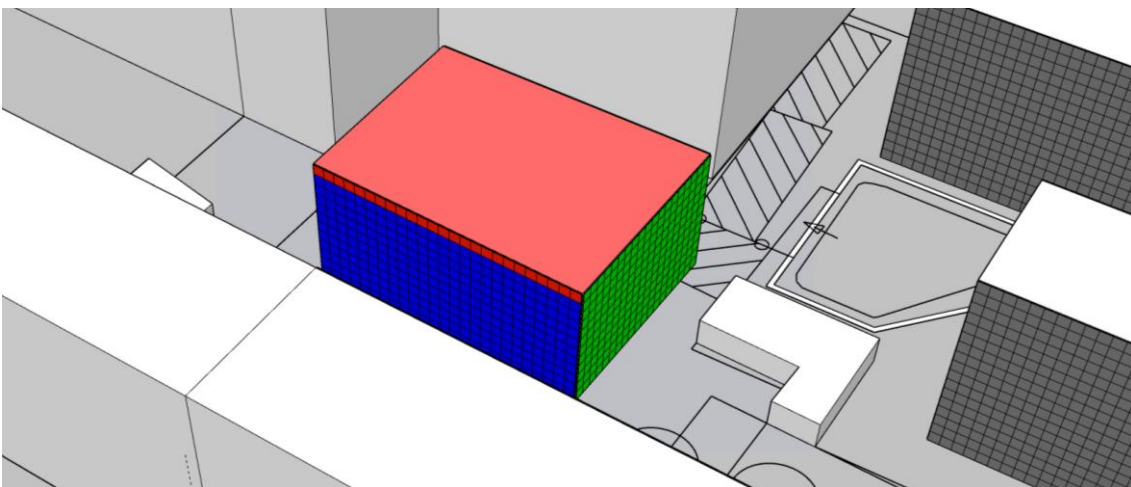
Planvariante mit angepasster Kubatur und Staffelgeschossen
